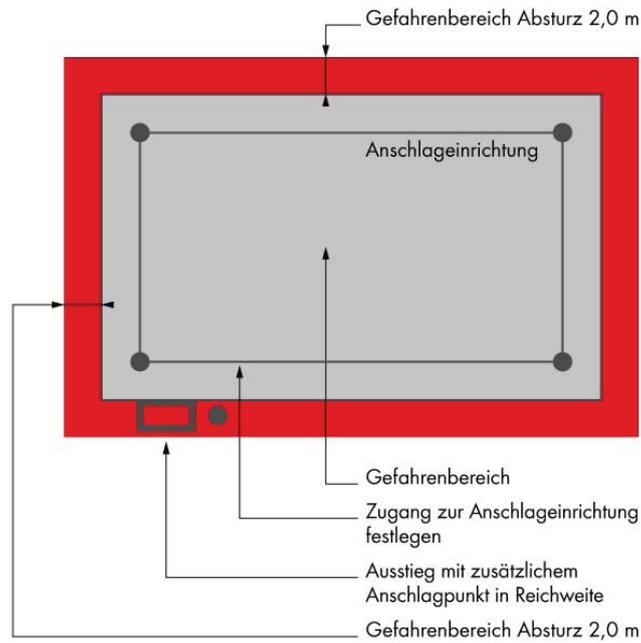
Absicherung des Zugangs zur Dachfläche mit einem Einzelanschlagpunkt [1]
